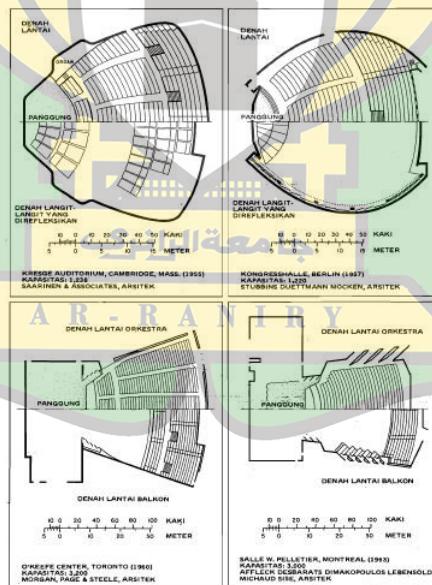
Contoh Denah Lantai bentuk Tidak Teratur
